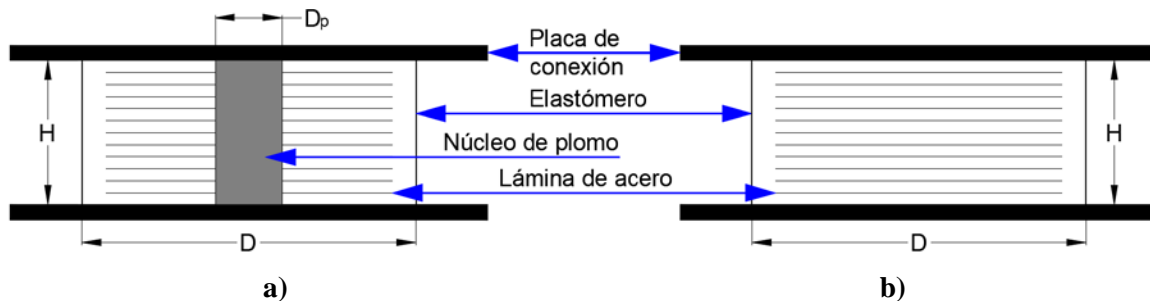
Componentes de un aislador tipo LRB (a) y HDRB (b)
